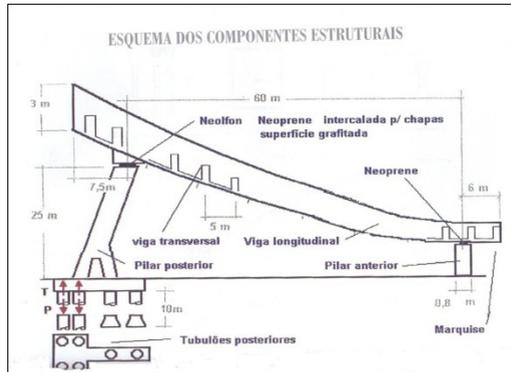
Esquema dos componentes estruturais da construção da catedral.
